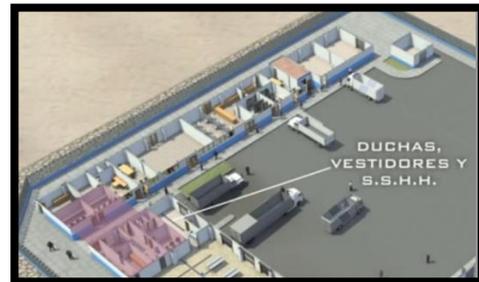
IMÁGENES ZONA ADMINISTRATIVA PUERTO BAHIA BLANCA -FUENTE: PLAN DE DESARROLLO PUERTO BAHIA BLANCA
